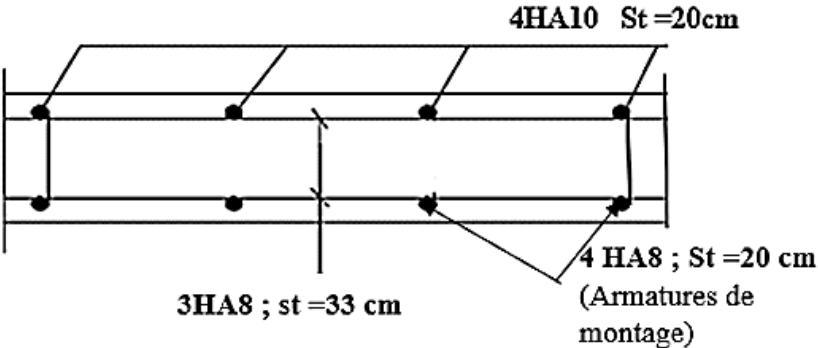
Schéma de ferrailage du balcon coup A-A
